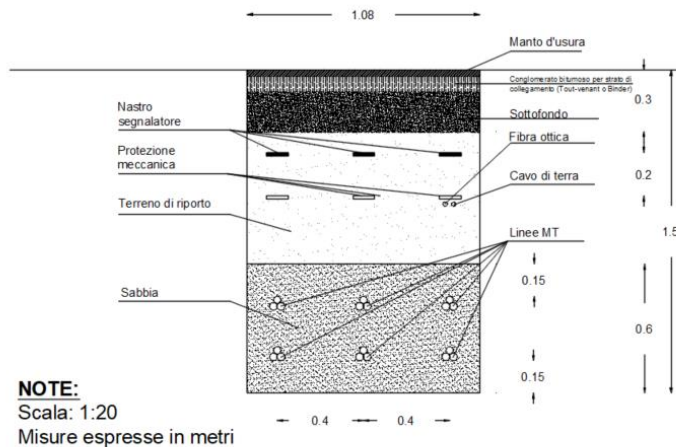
Stralcio elaborato "FOM.ENG.TAV.031. _Planimetria dei cavidotti con indicazione delle sezioni di posa" – Sezioni per interrimento del cavidotto MT
